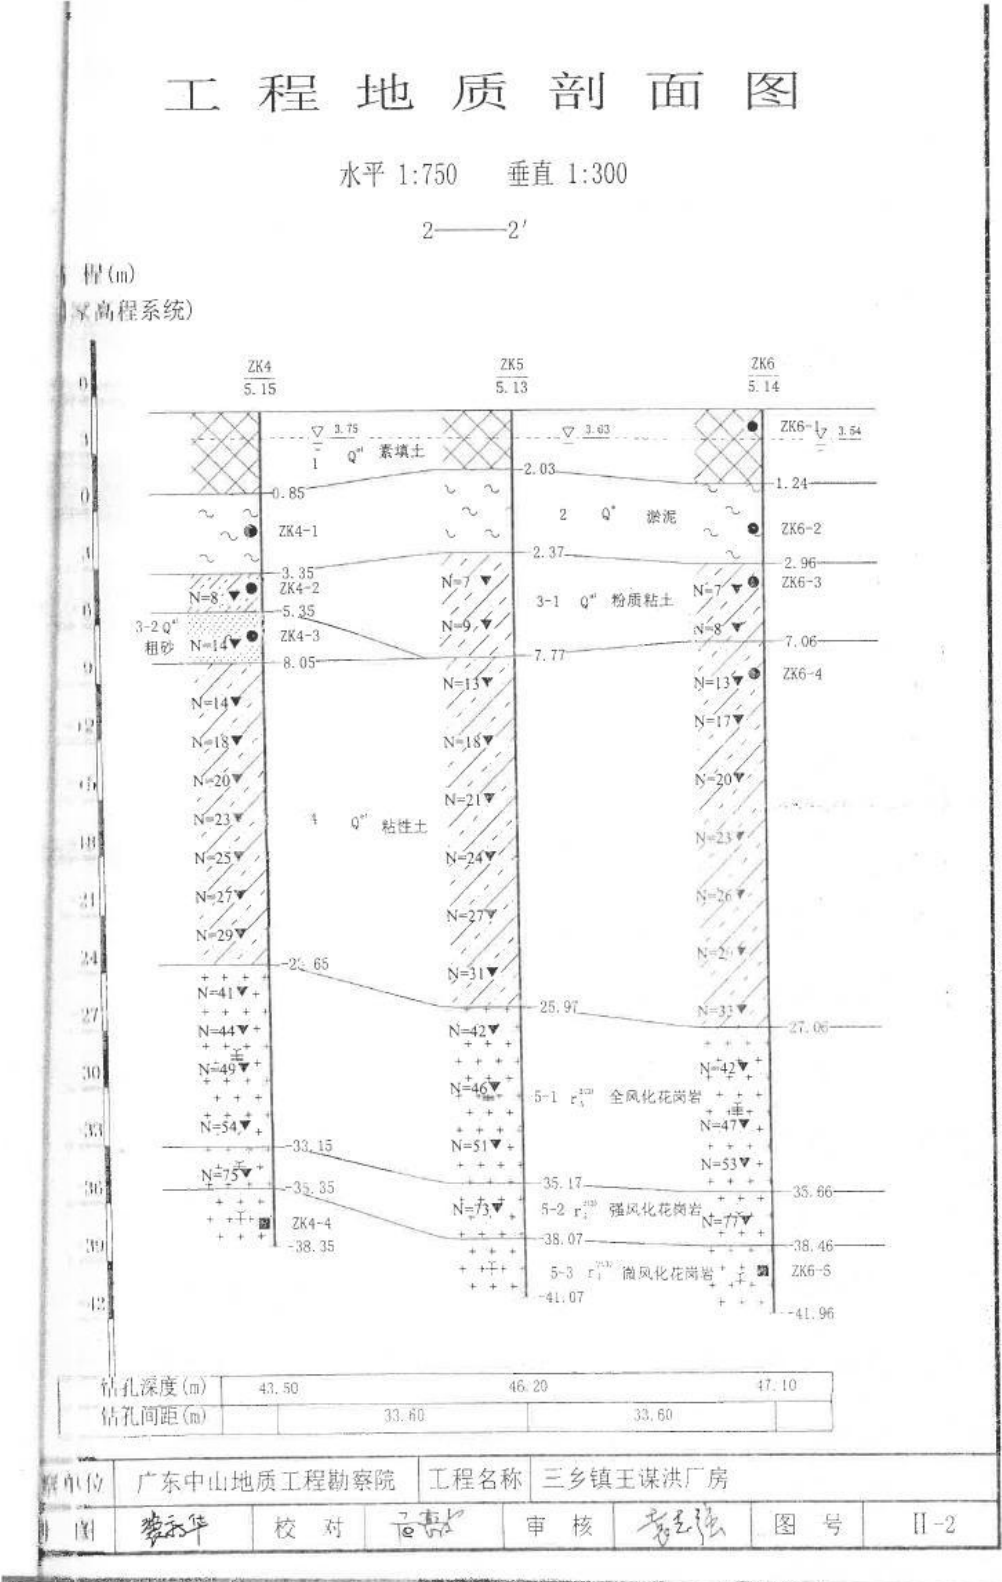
岩土勘察工程地质剖面图 (2-2 剖面)
